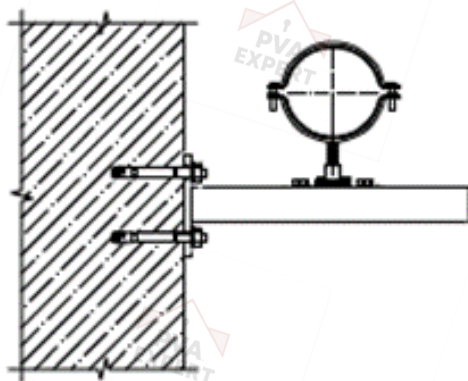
Узел крепления трубы к стене на скользящей опоре (скользящая опора)
